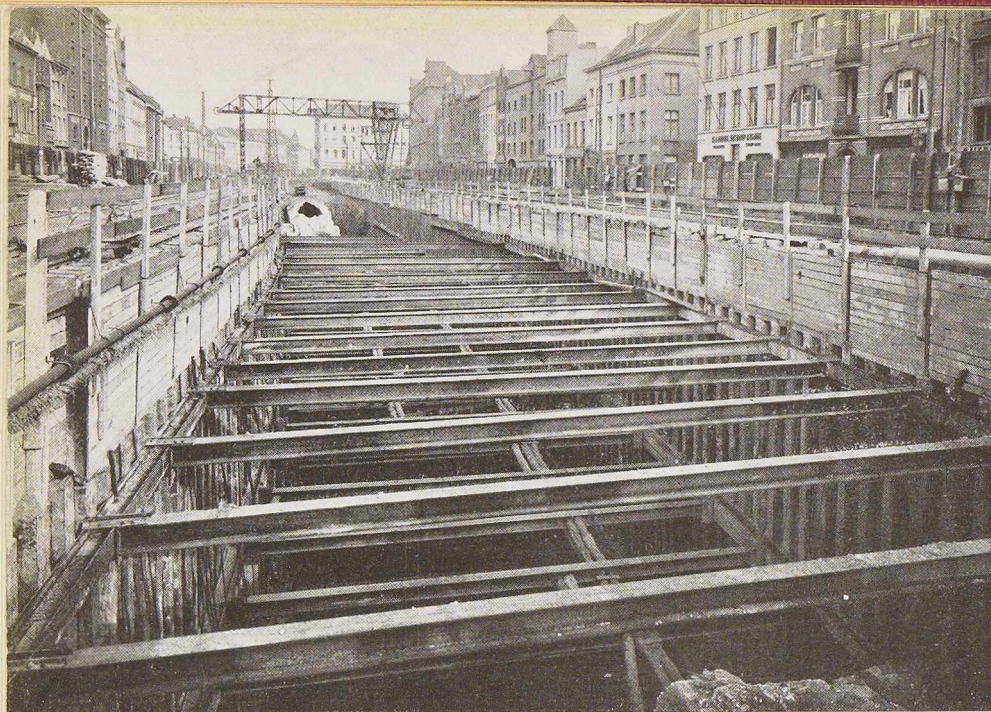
Tunnel sous l'Escaut à Anvers. Etançonnage des rideaux de palplanches au moyen de poutrelles Grey de Differdange.
